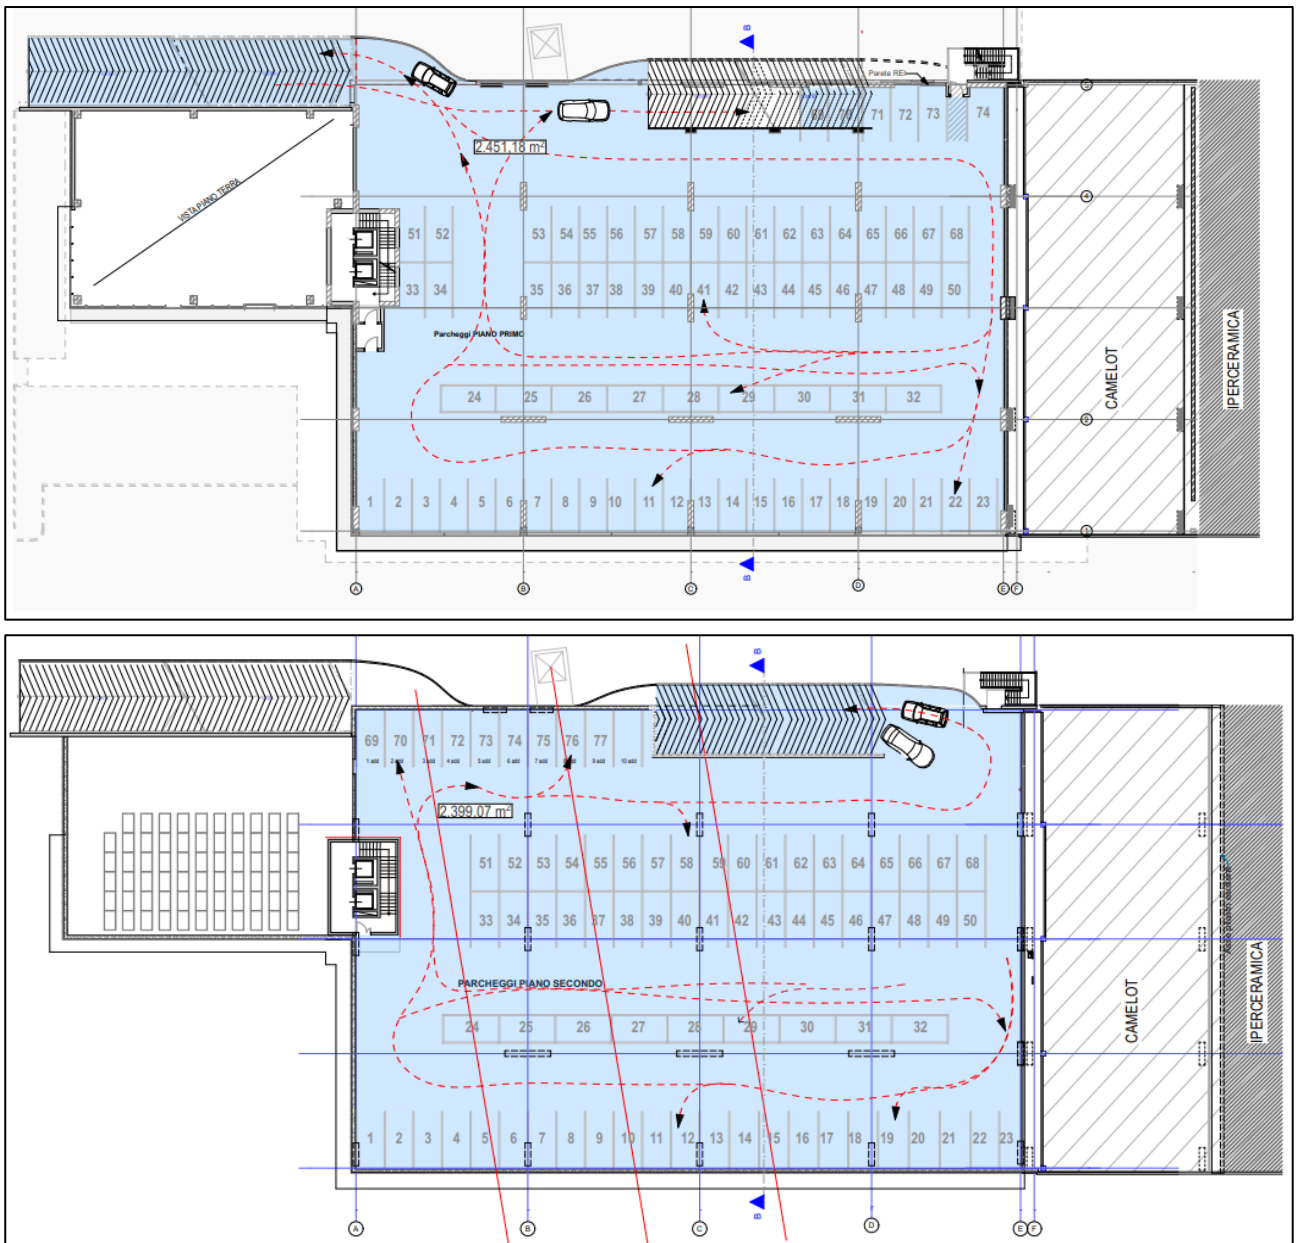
Planimetria di progetto delle aree di sosta al piano primo e secondo.
